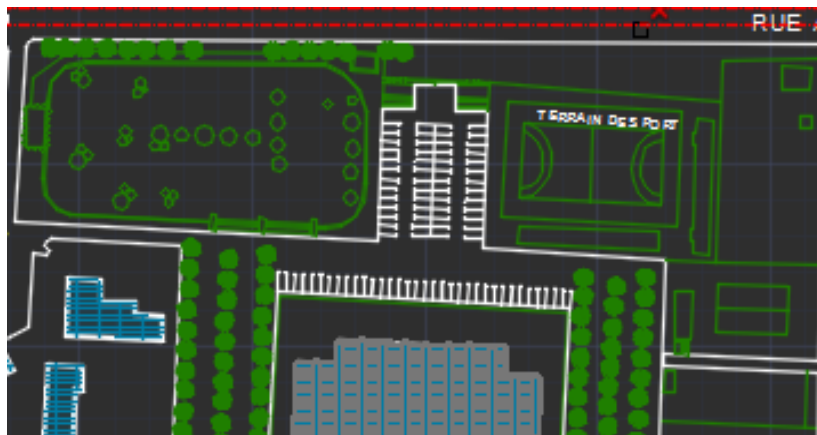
vue en plan de la place EGTA avant l'intervention/source : auteurs
